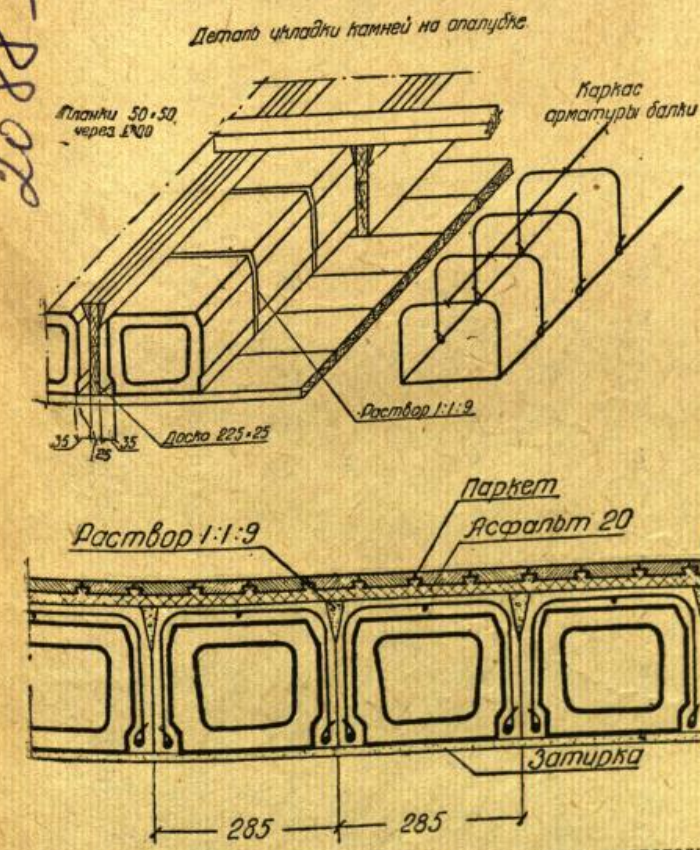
Сборное железобетонное перекрытие из пустотелых сборных балок.
